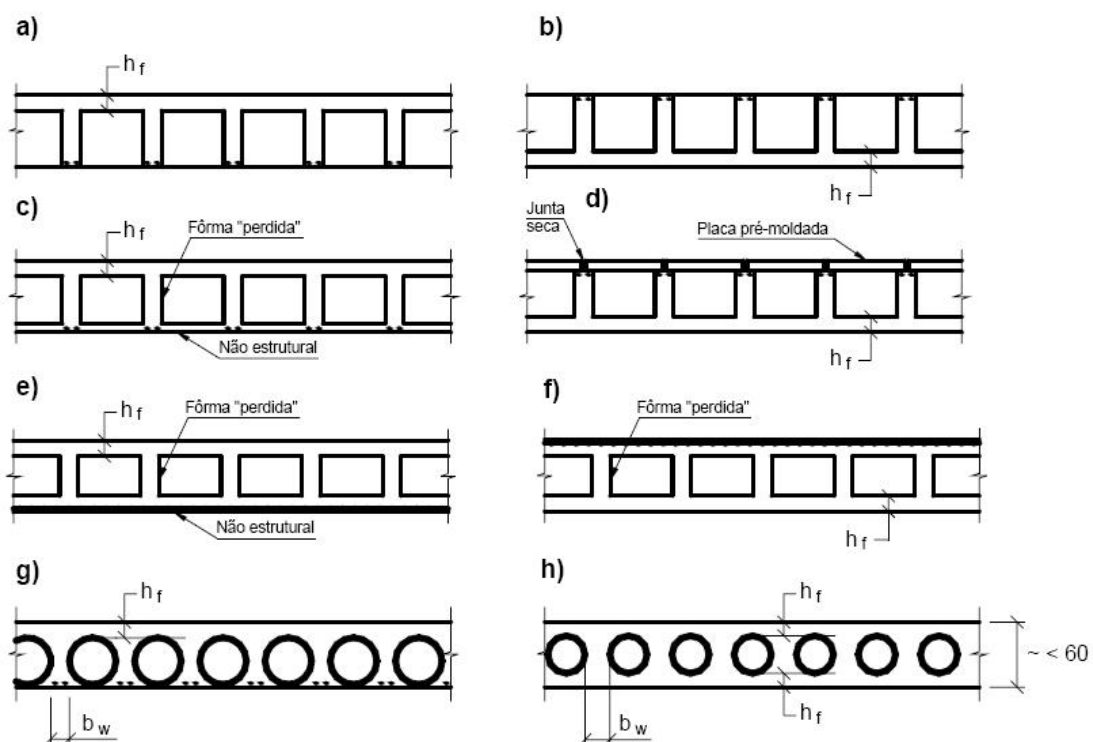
Várias disposições possíveis para as lajes nervuradas (ANDRADE, 1982).
